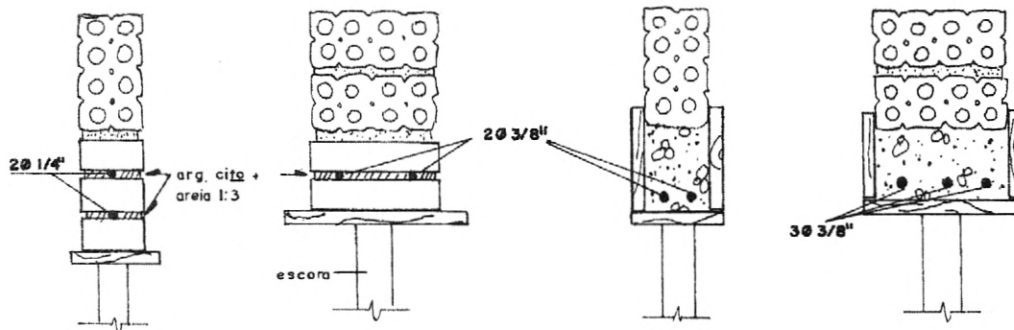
Vergas em alvenaria de tijolo furado para vãos até 1,00m e entre 1,00m e 2,00m
